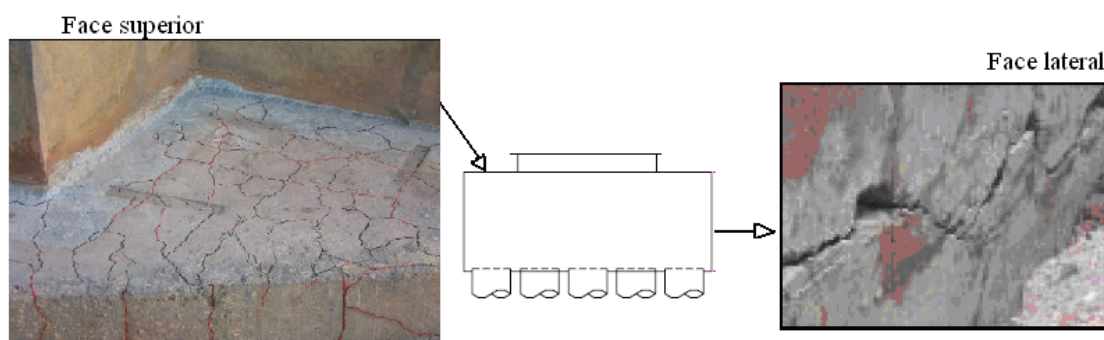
Fissuras e trincas nas faces do bloco Fonte: FIGUEIRÔA, (2006)
